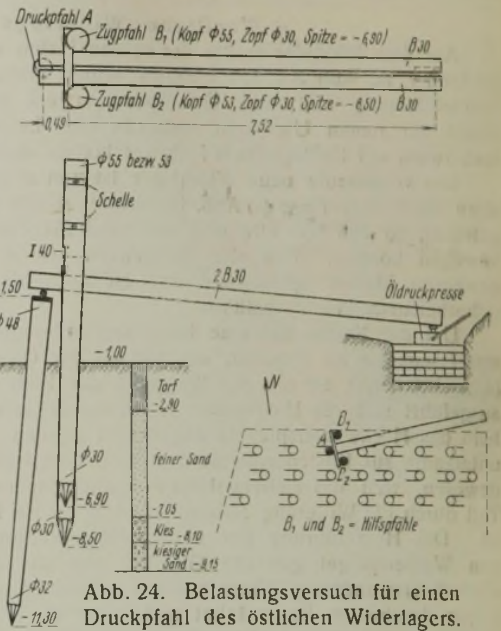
Belastungsversuch für einen Druckpfahl des östlichen Widerlagers.
